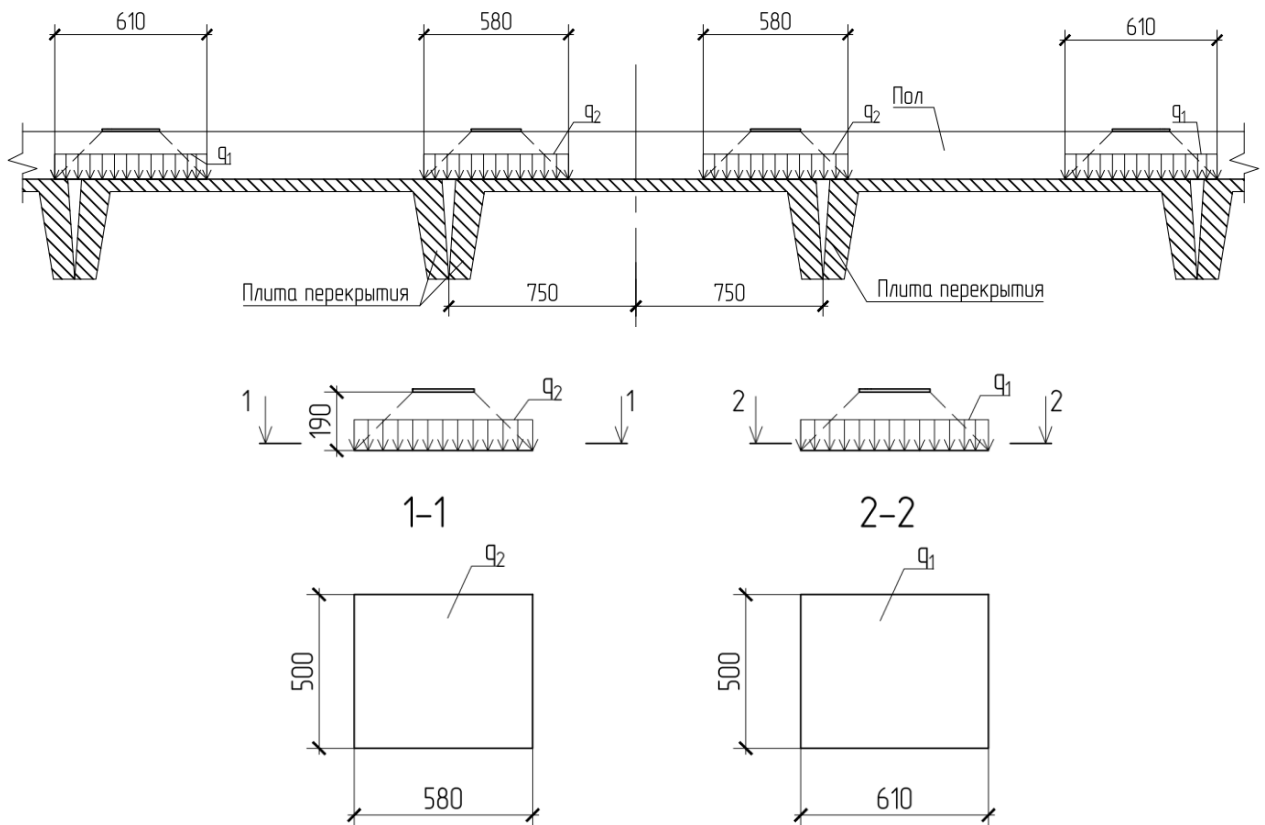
Схема передачи нагрузки от технологического оборудования на плиты перекрытия
